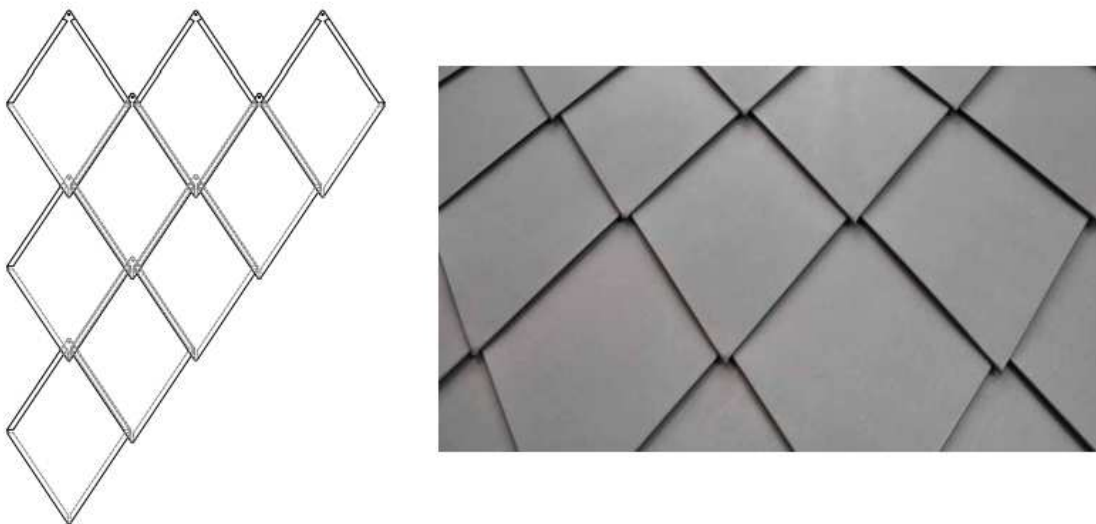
Sistema de fixação da “Vmzinc” [6]
